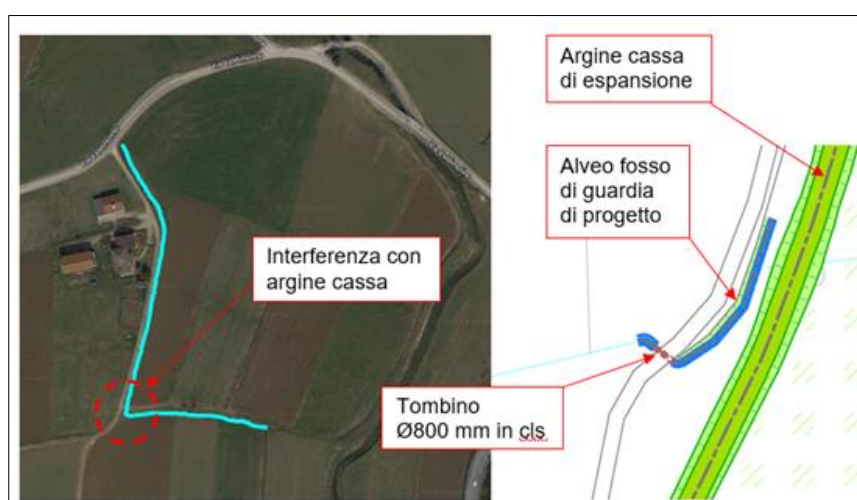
Estratto ortofotografico e planimetrico del fosso di guardia interferente con l'argine della cassa
